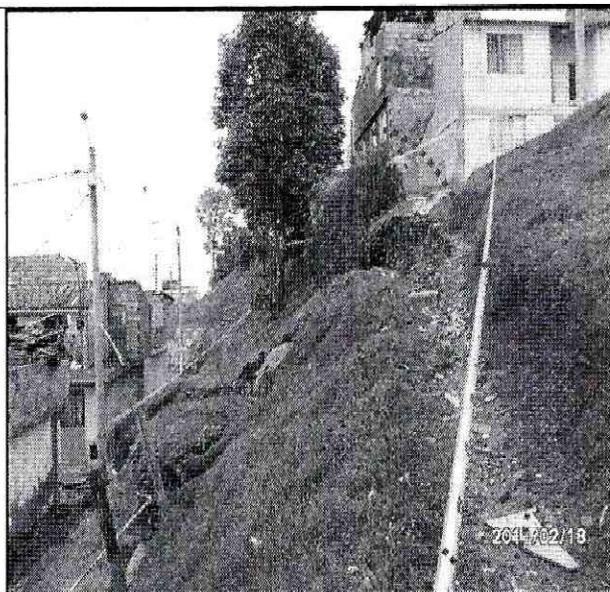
Vista de la parte media de la ladera entre las terrazas 1 y 2 donde se evidencia que el material que se encontraba en la parte alta fue arrastrado por las fuertes lluvias hasta la cancha.
